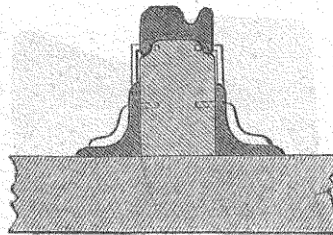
Voies ferrées belges. Section du rail, etc. 26 kil. par mètre courant. Échelle 1/16.
